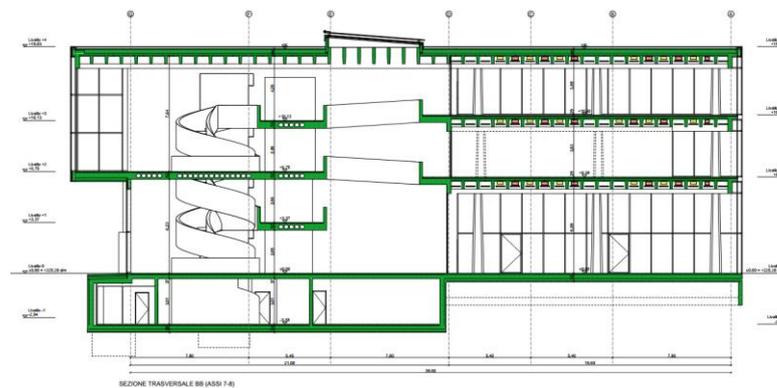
Sezione trasversale BB – Durisch + Nolli Architetti sagl
